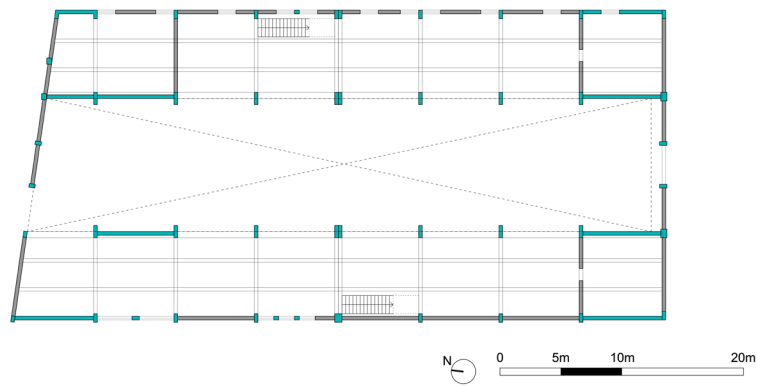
Planimetría Galpón Sur Ex Fundición Metalco. Fuente: elaboración propia.
